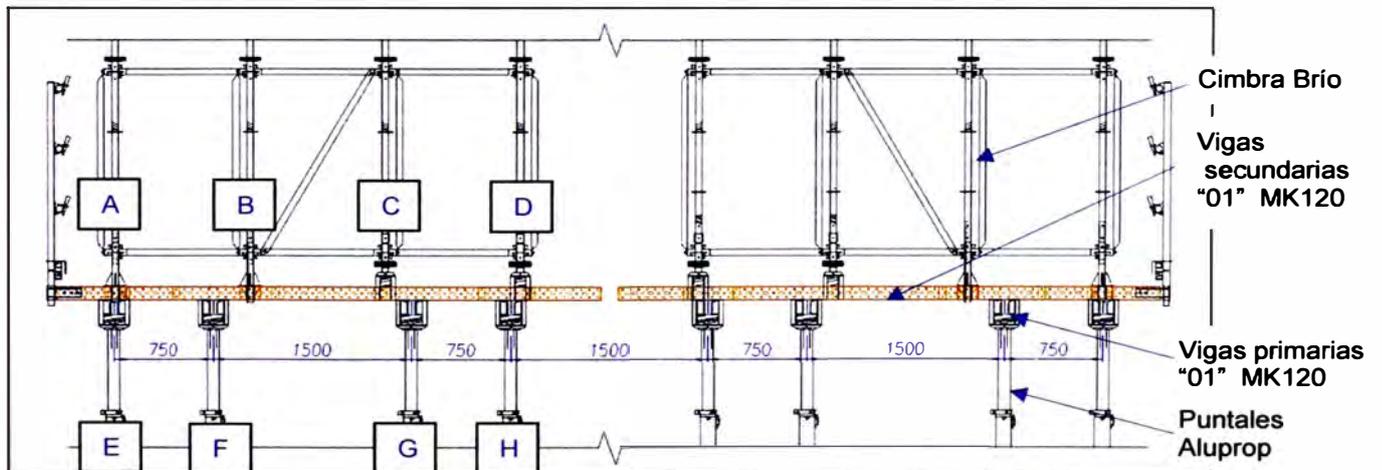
Sección típica – vigas secundarias "01" sección 1-6 (mm).
